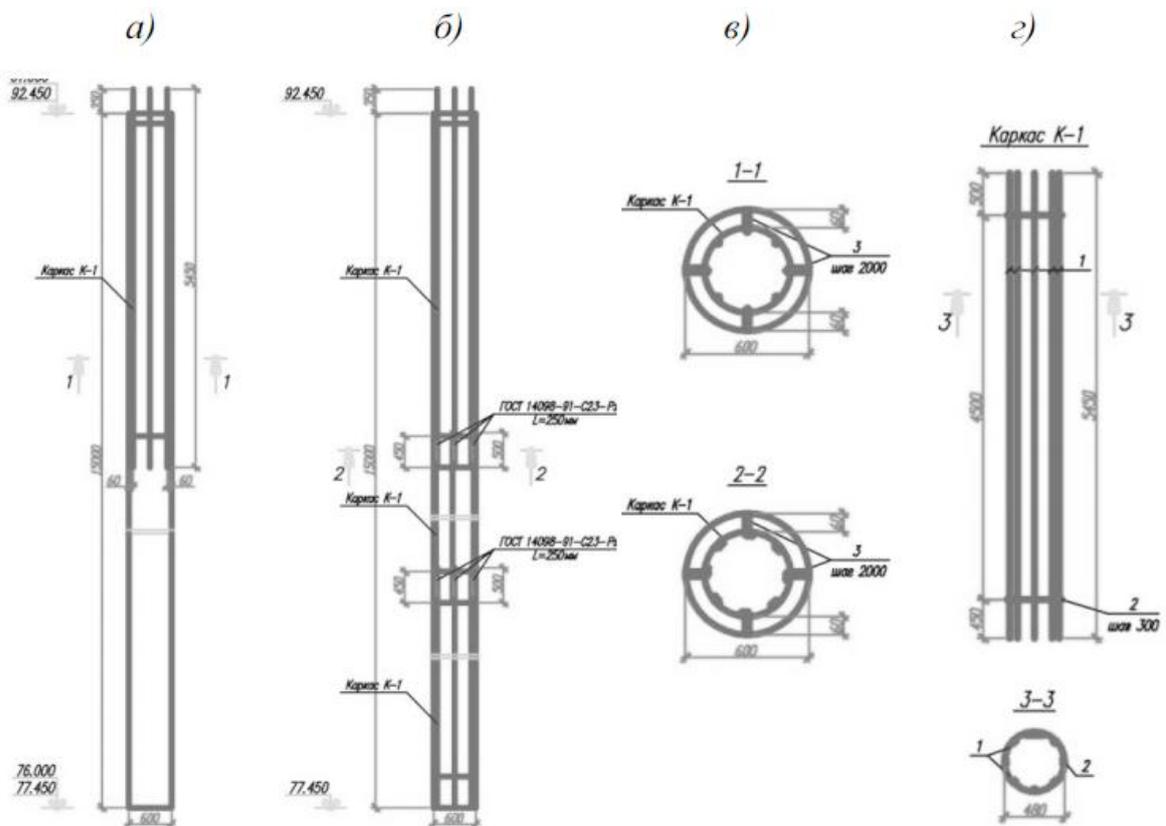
Конструкции: буронабивных свай БС-1 (а) и БС-2 (б); в – поперечные сечения 1-1 и 2-2 по БС-1 и БС-2; г – секции арматурного каркаса К-1 для БС-1 и БС-2
